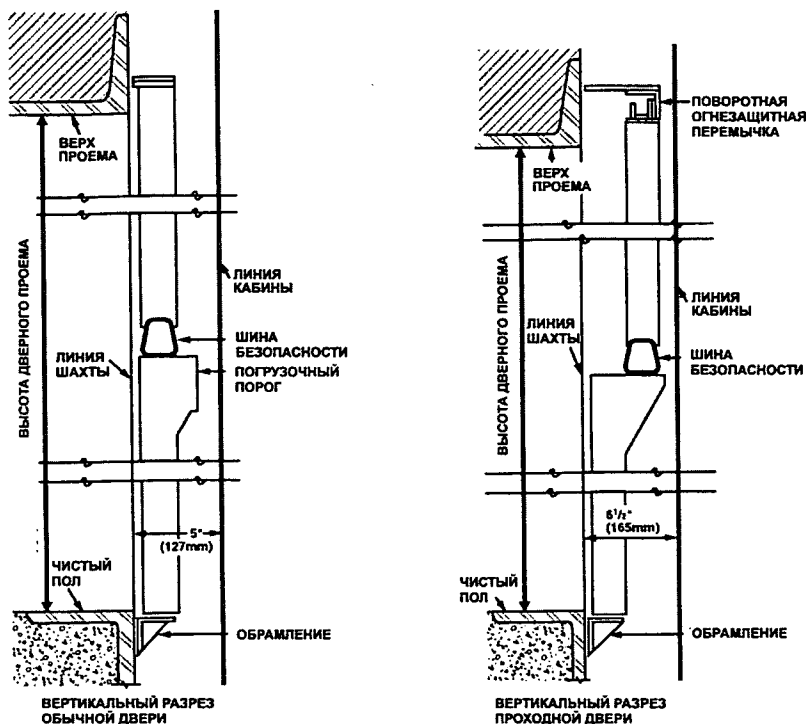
Вертикальный разрез дверей центрального открывания
